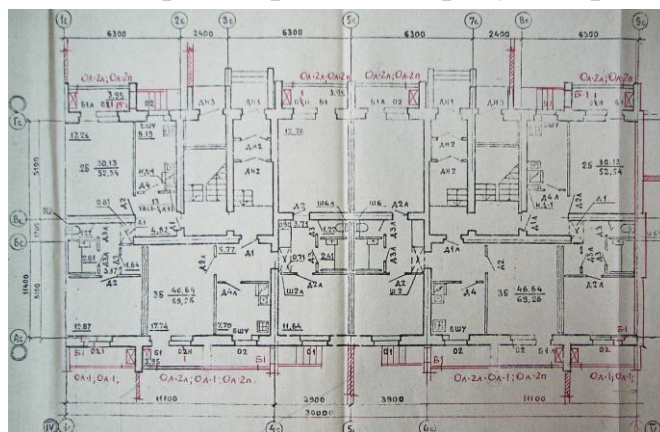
Рядовая блок-секция 86-04. План первого этажа жилого дома по ул. 9 Мая, д. 28. Квартиры с выходом в палисадники
